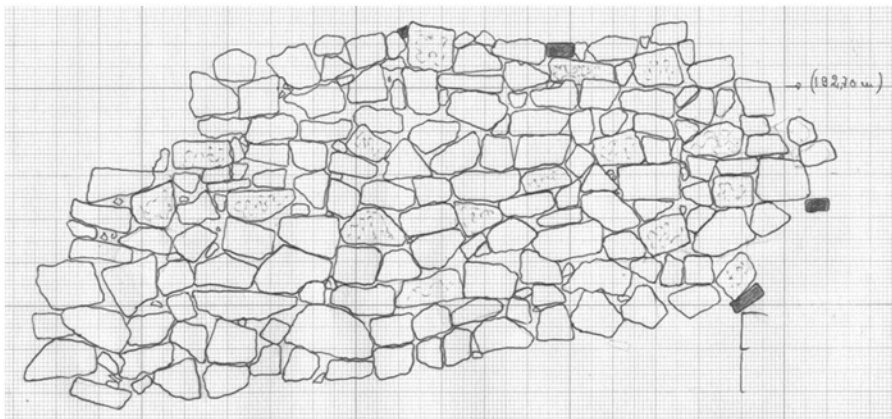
Muro 83 - Ed.PT (desenho UAUM)
